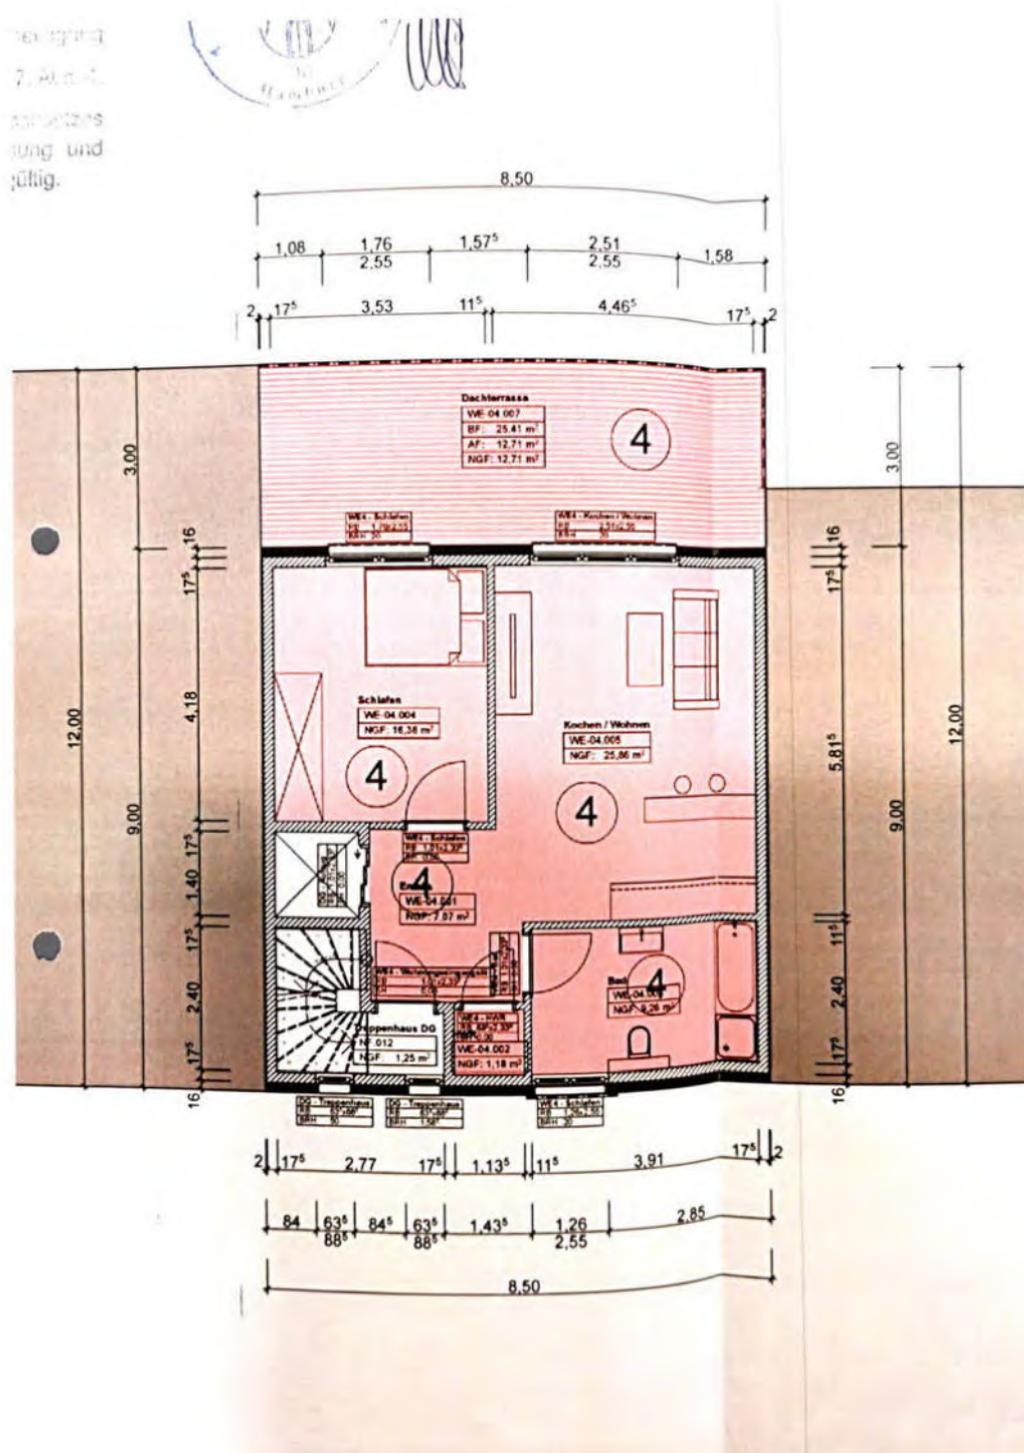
Teilgrundriss DG mit Wohnung Nr. 4
